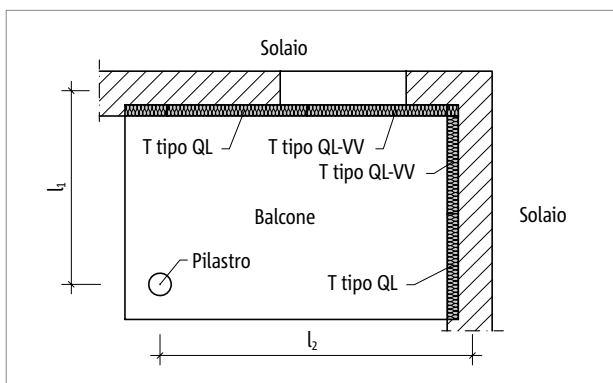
Schöck Isokorb® T tipo QL, QL-VV: balcone con appoggio su due lati e pilastro
